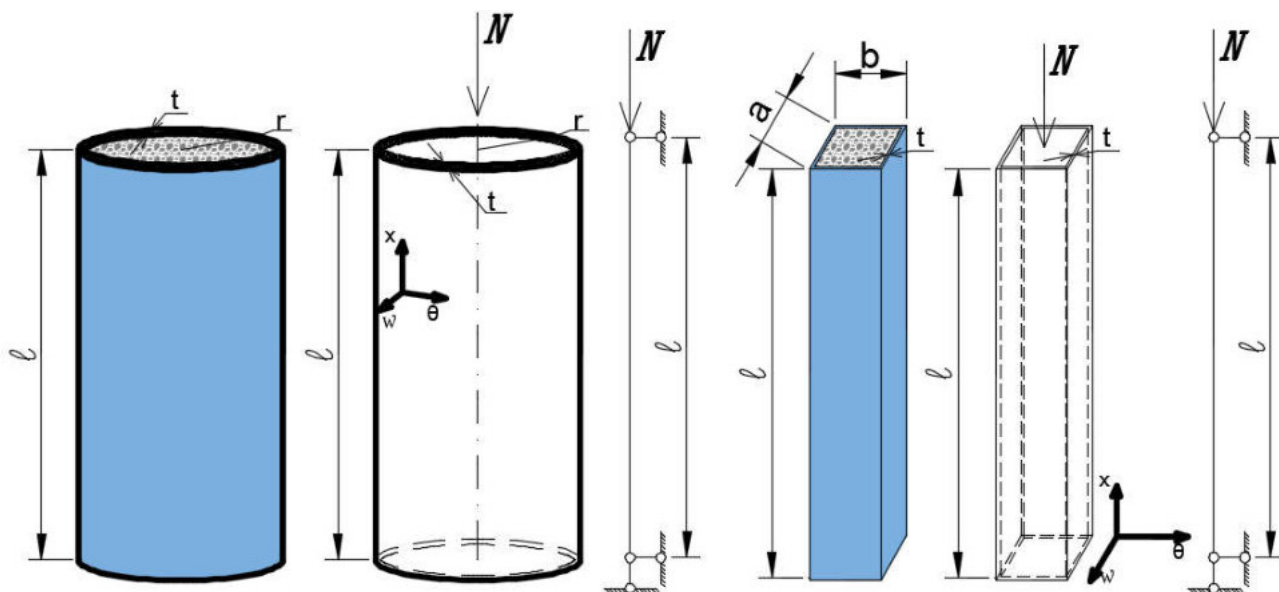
Розрахункові схеми трубних конструкцій
